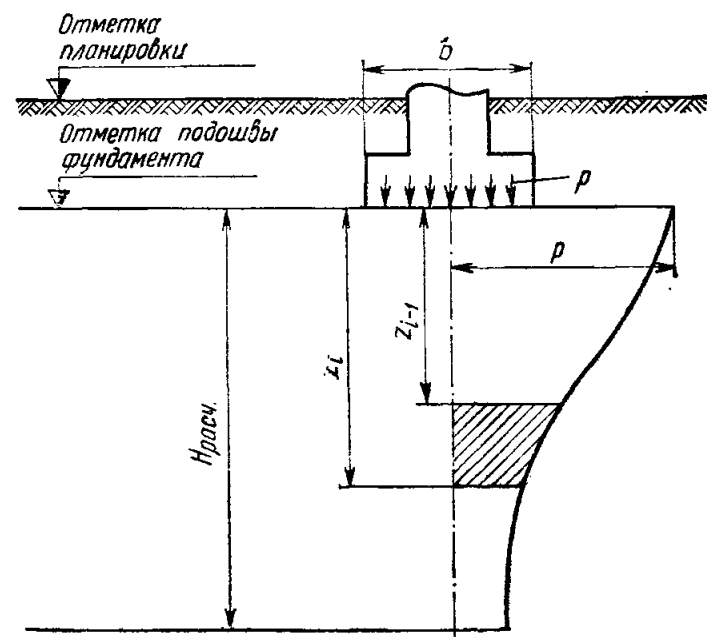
Схема для расчета осадок методом линейно-деформируемого слоя конечной толщины
